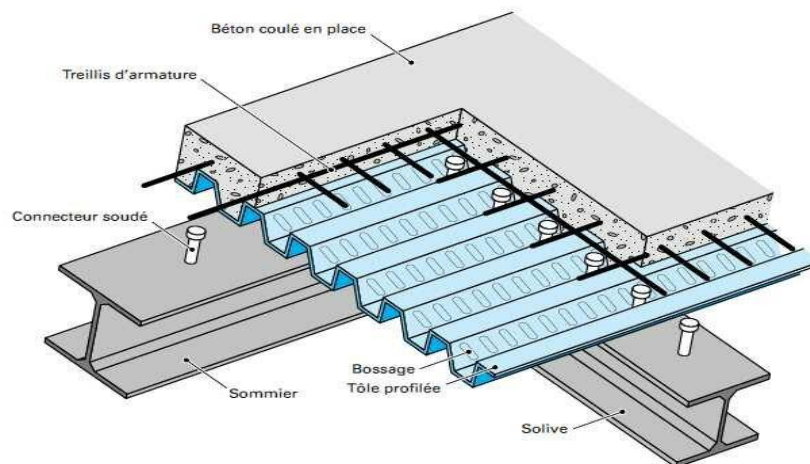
Éléments constructifs d'un plancher collaborant
